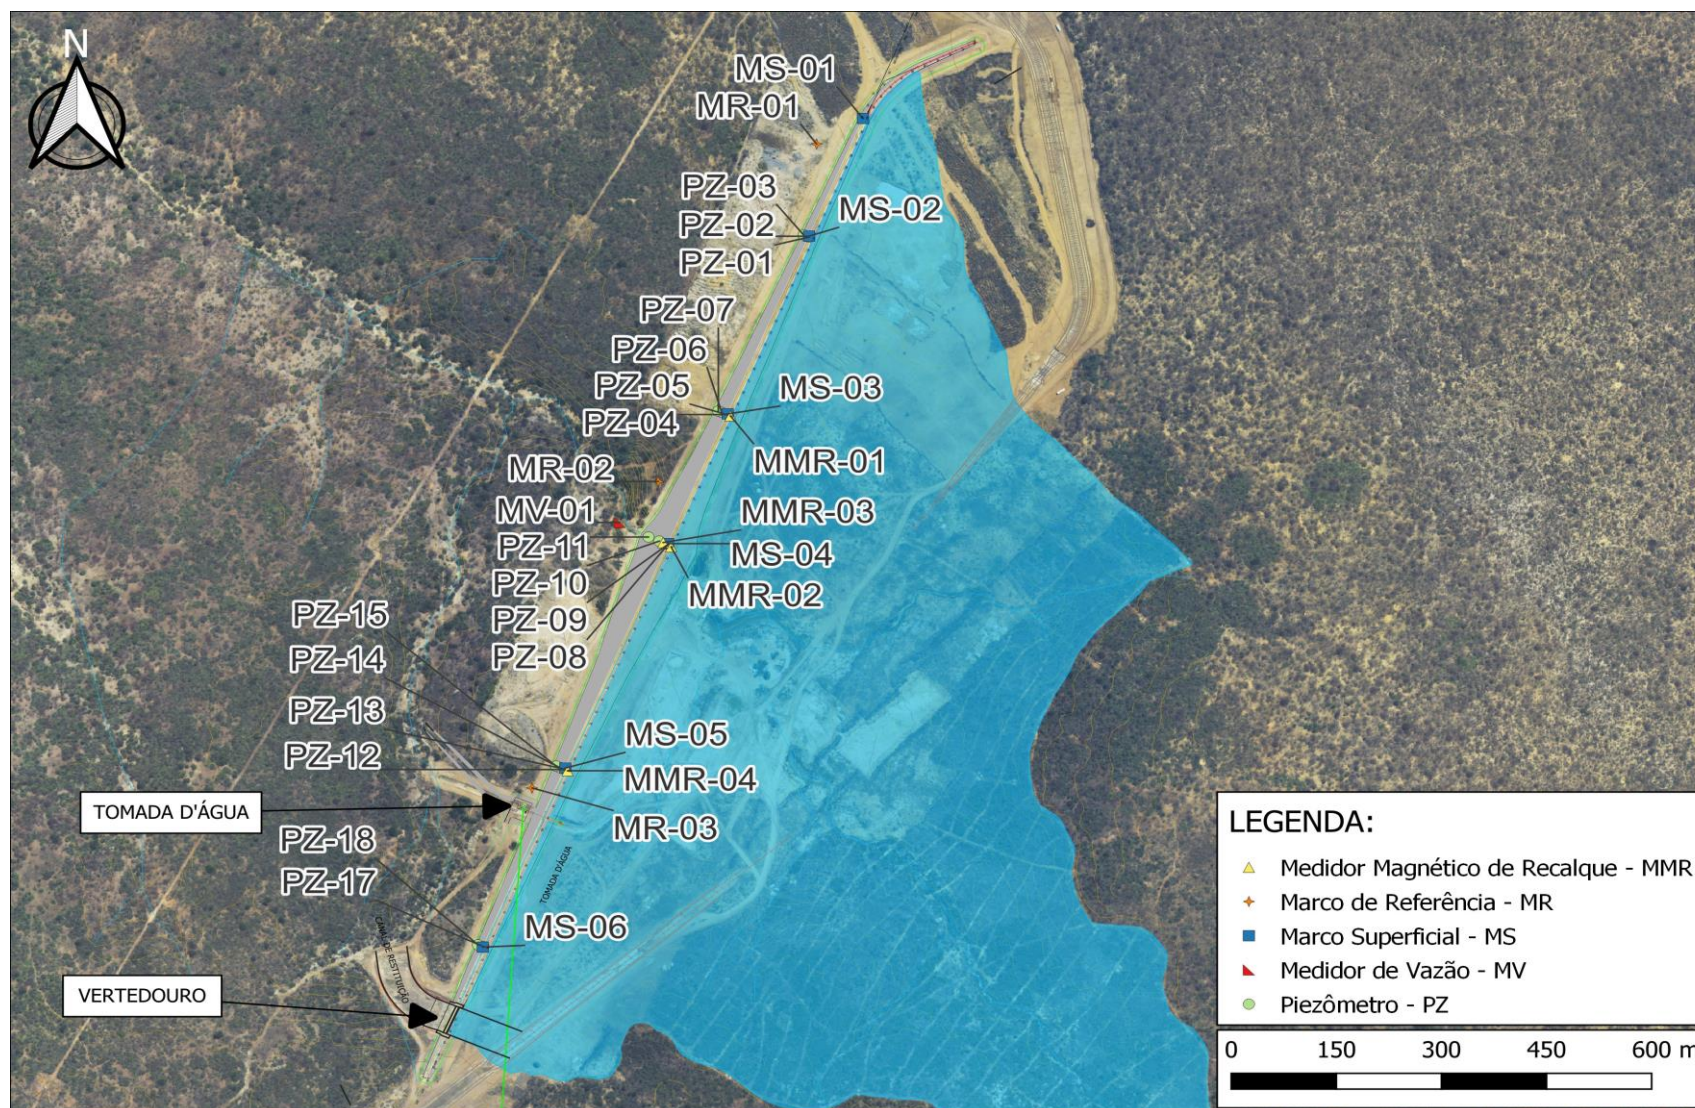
Planta de localização da Instrumentação da Barragem Salgueiro. Fonte: Projeto As Built n.º 1303-DEP-2107-20-04-001-R00 modificado/Google Satélite DATUM SAD 69.
